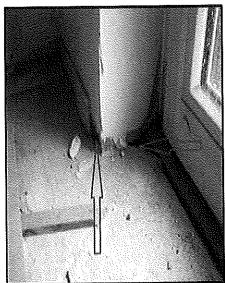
Flux d'air au niveau des liaisons périphériques (parois, plancher) dans le séjour
